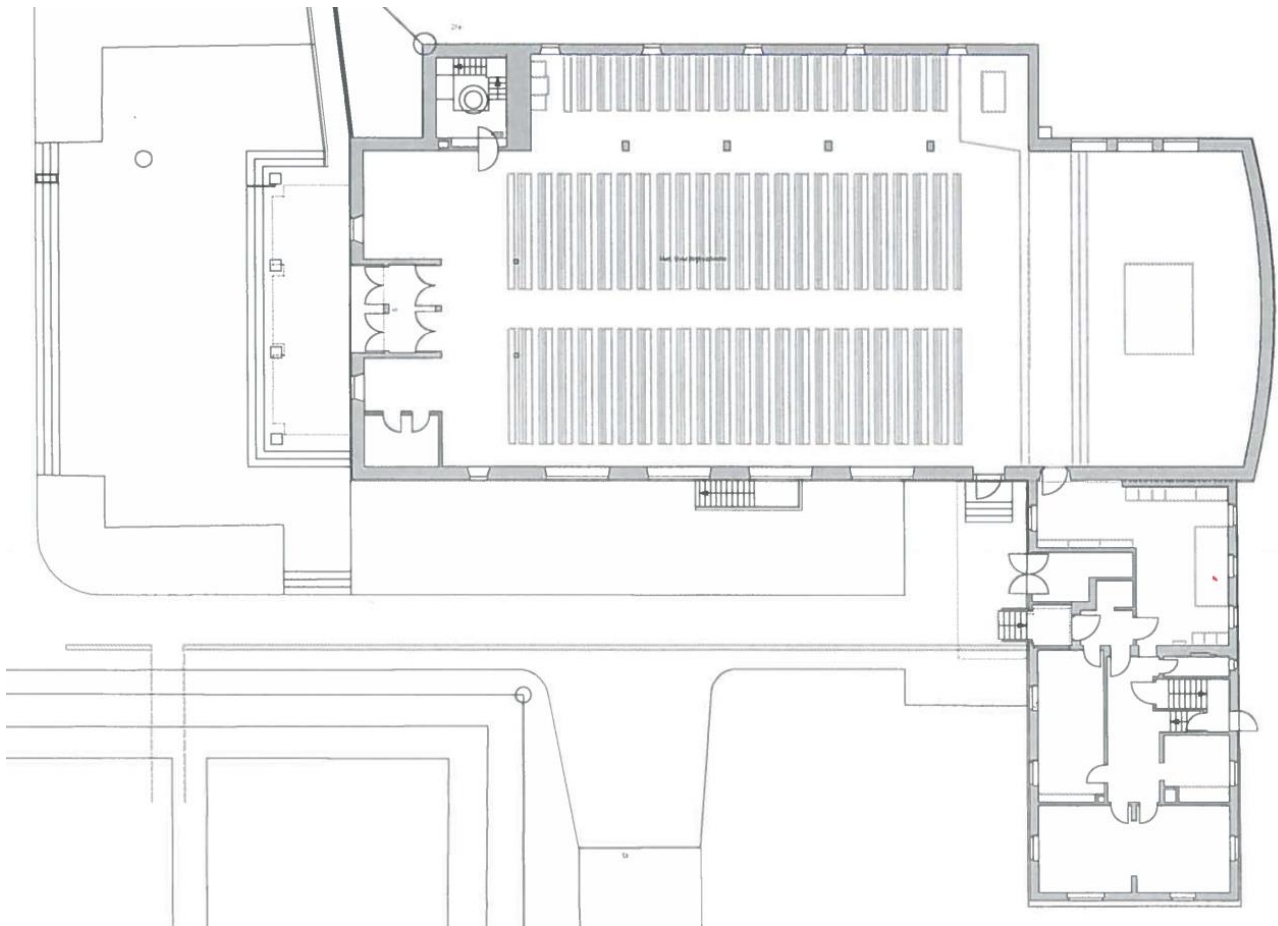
Grundriss (EG) von Kirche und Pfarrhaus
